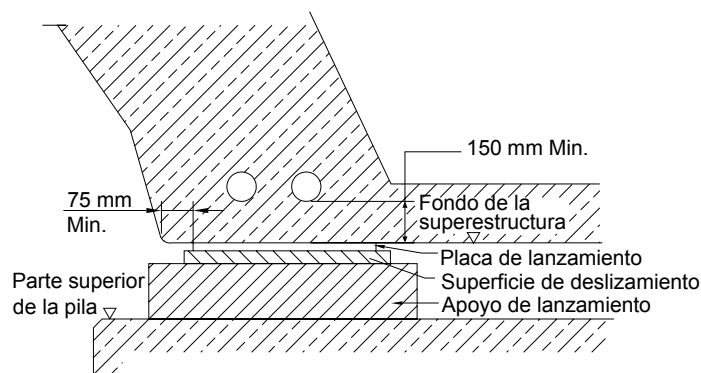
1 – Ubicación de las placas de lanzamiento
